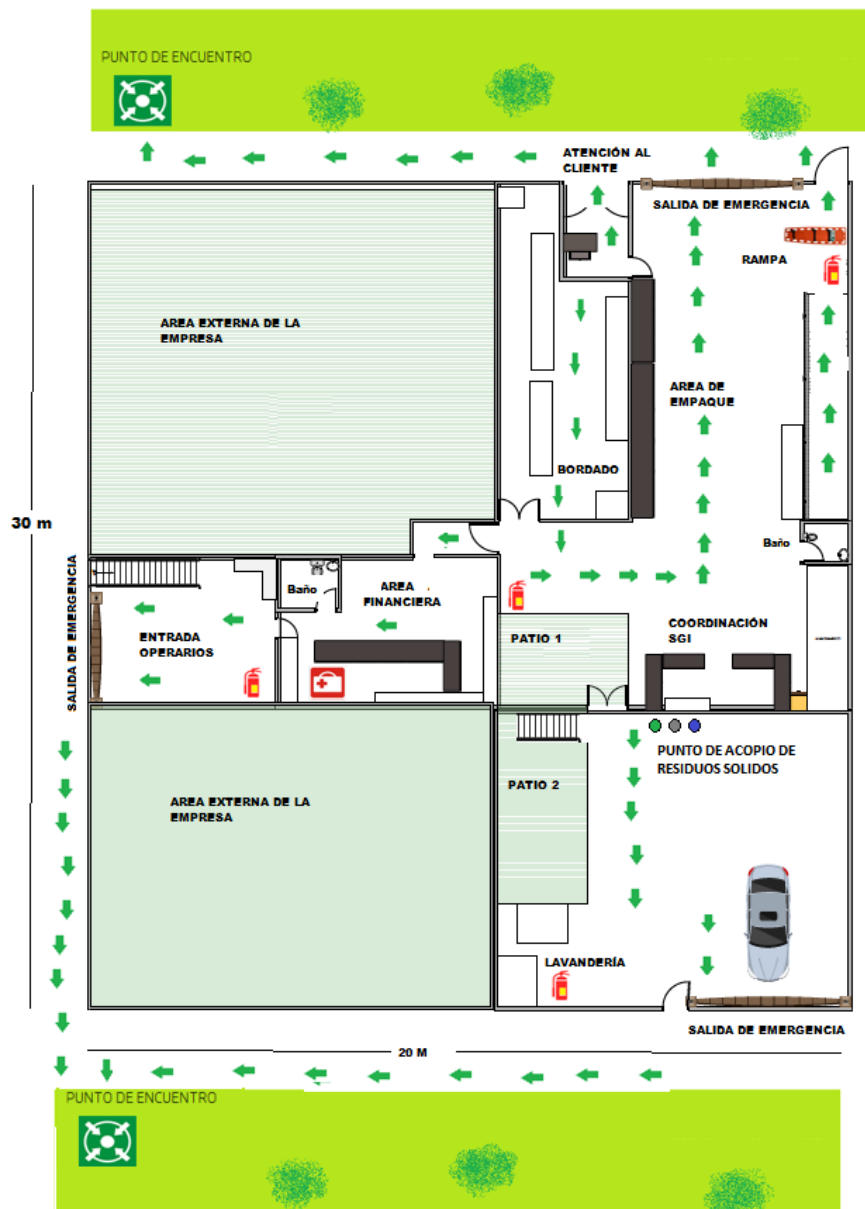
Plano de la primera planta del edificio de Maranata Uniformes S.A.S.
